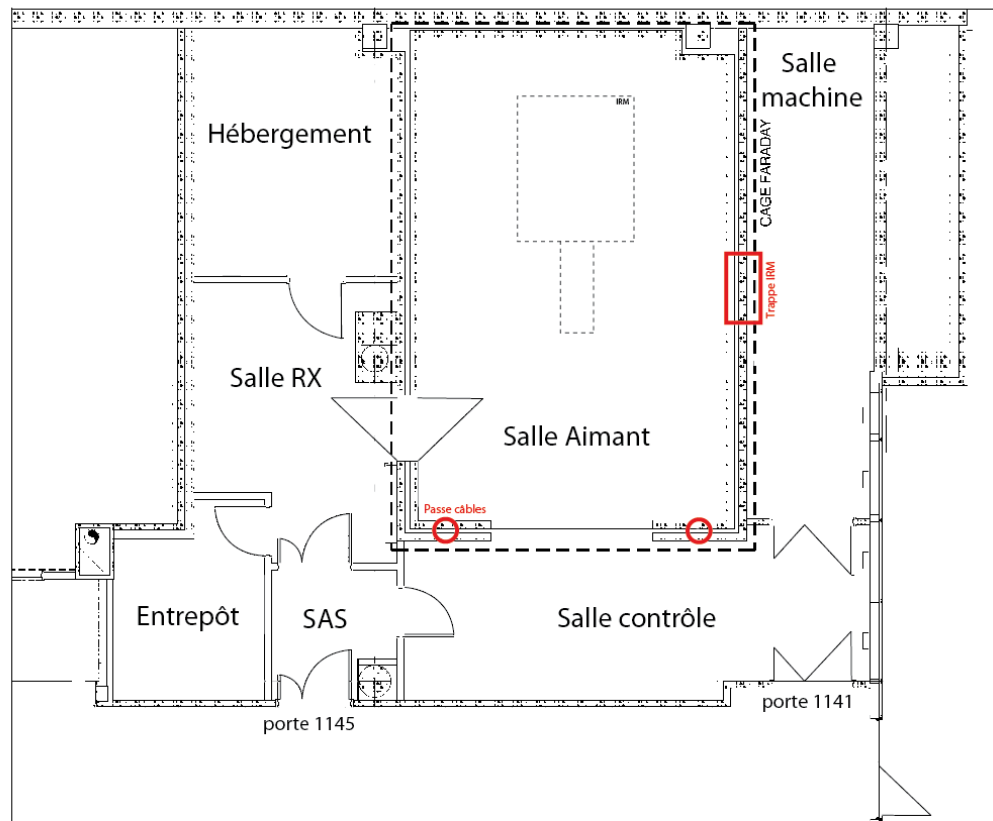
Plan du laboratoire IRM, à l'UNIM
